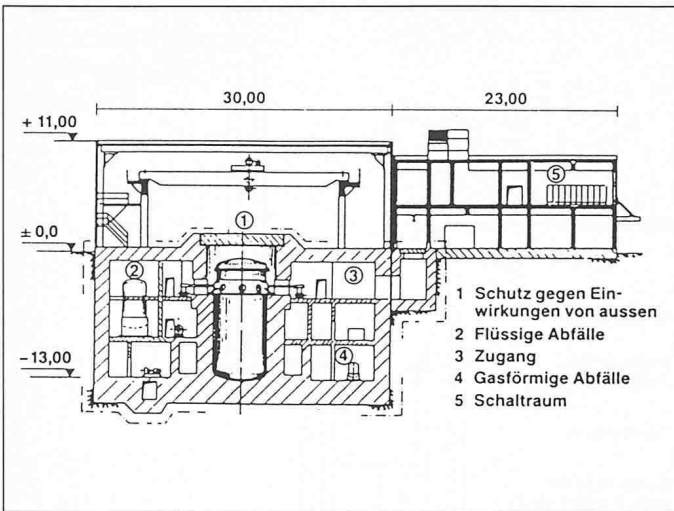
Schnittbild des KWU-Reaktors (BRD)
